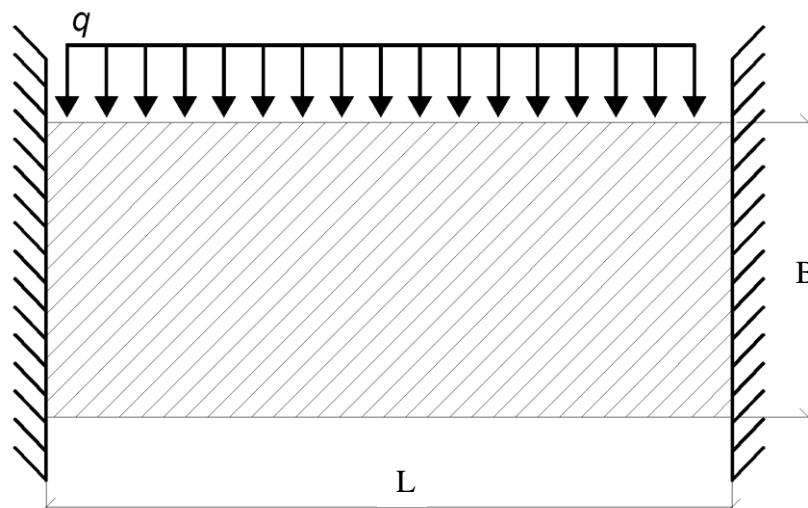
9 – Definição das dimensões em planta do pavimento para determinação de  $z$ .
